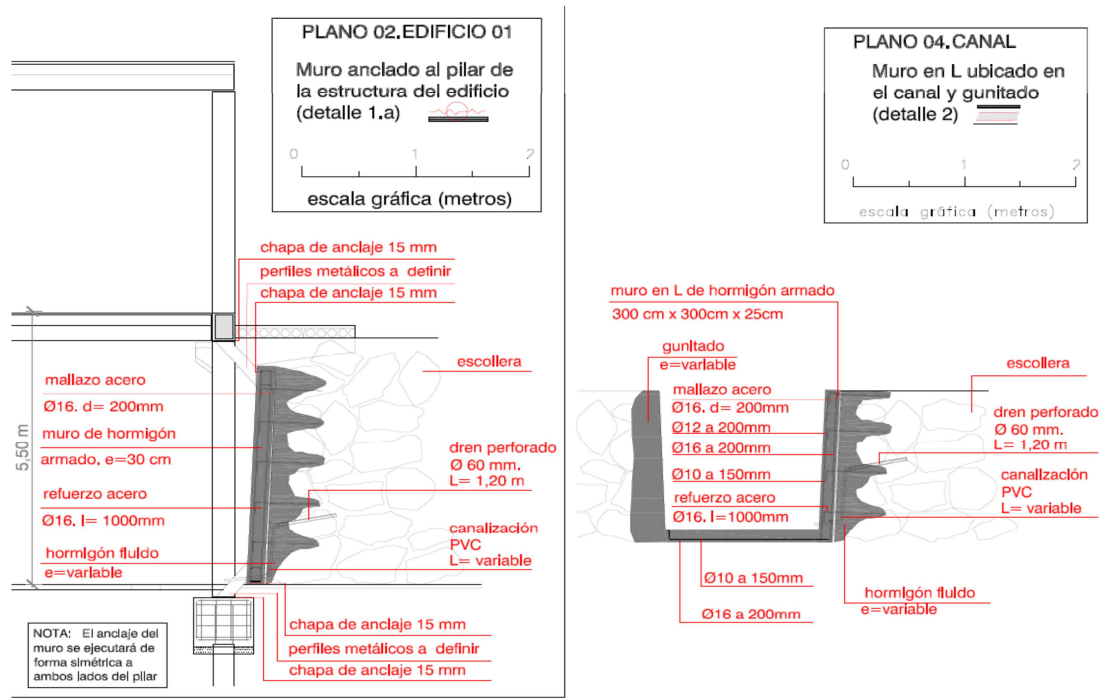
“Detalle del muro” y Fig 11 “Detalle del muro en canal junto a los edificios”.
